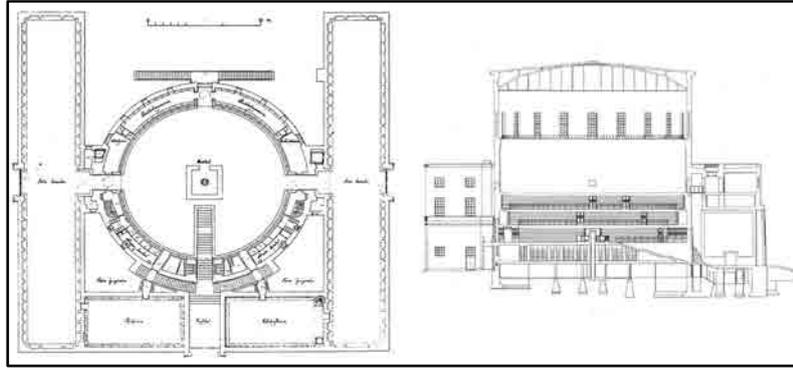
Planta e corte da Biblioteca Publica de Estocolmo
